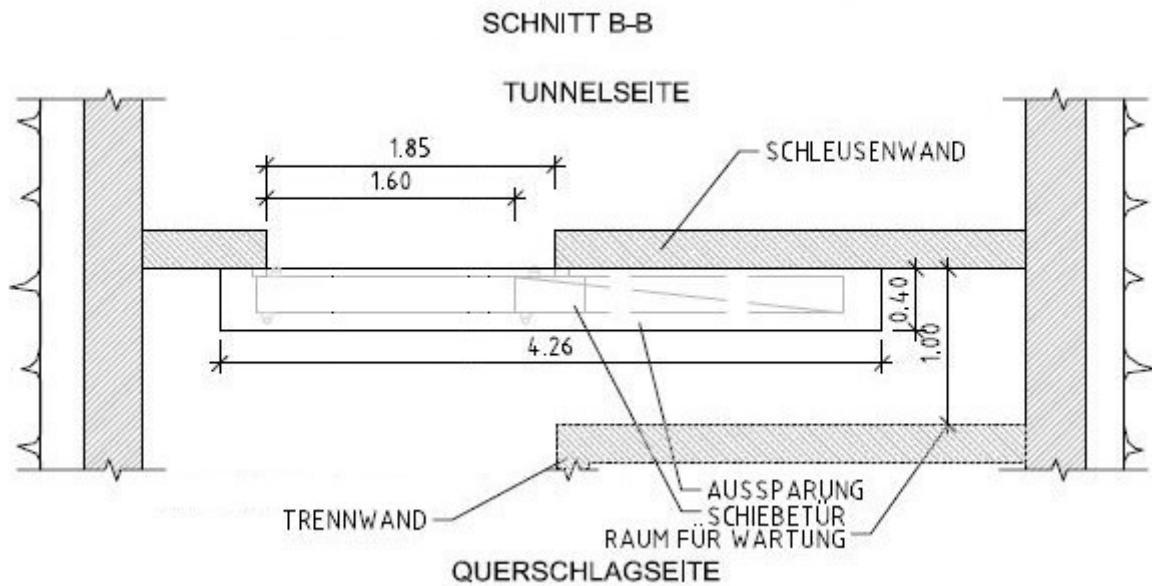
Querschlag SBT – Schiebetür 1,60 m x 2,20 m (Grundriss)
